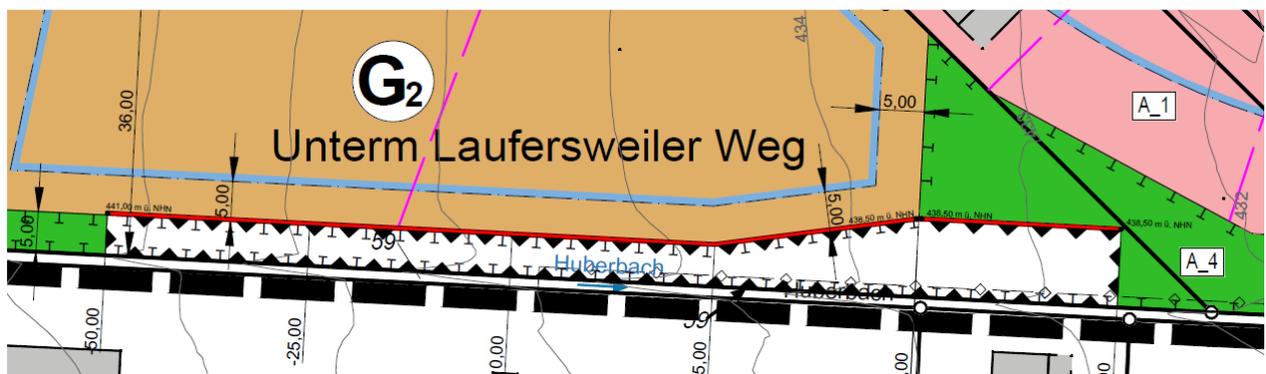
Auszug Planzeichnung – Lage Lärmschutz
